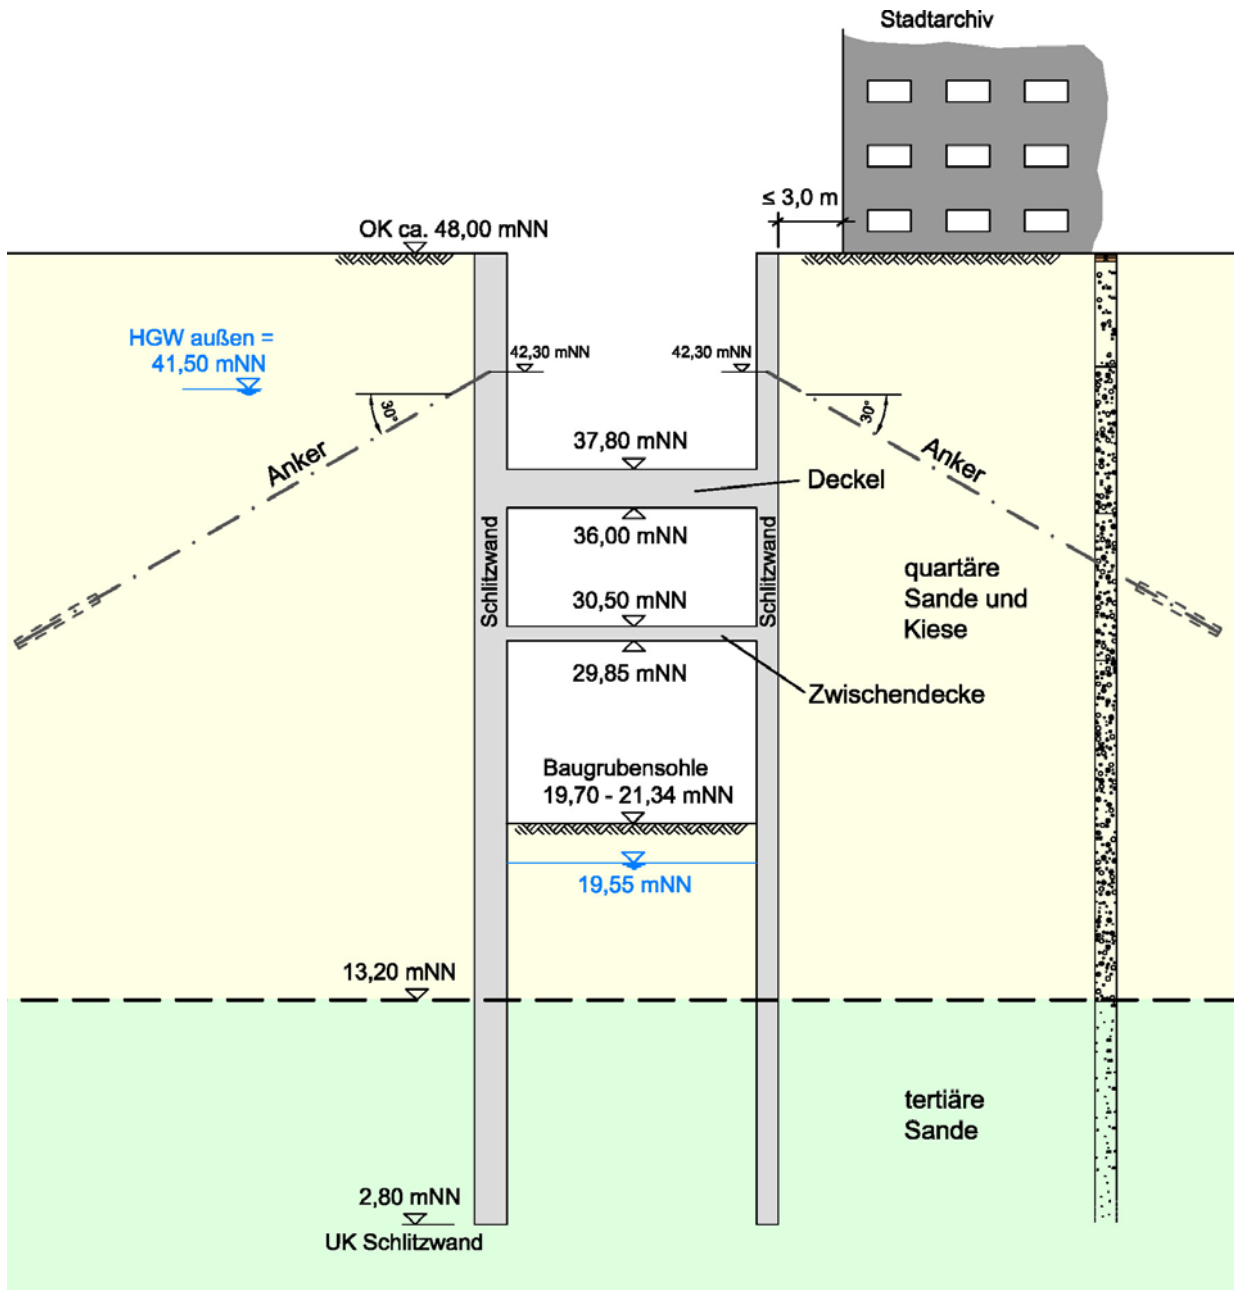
Schnitt durch die Baugrube Waidmarkt am Stadtarchiv Köln (Baugrunddarstellung gemäß Ausschreibungsunterlagen)
